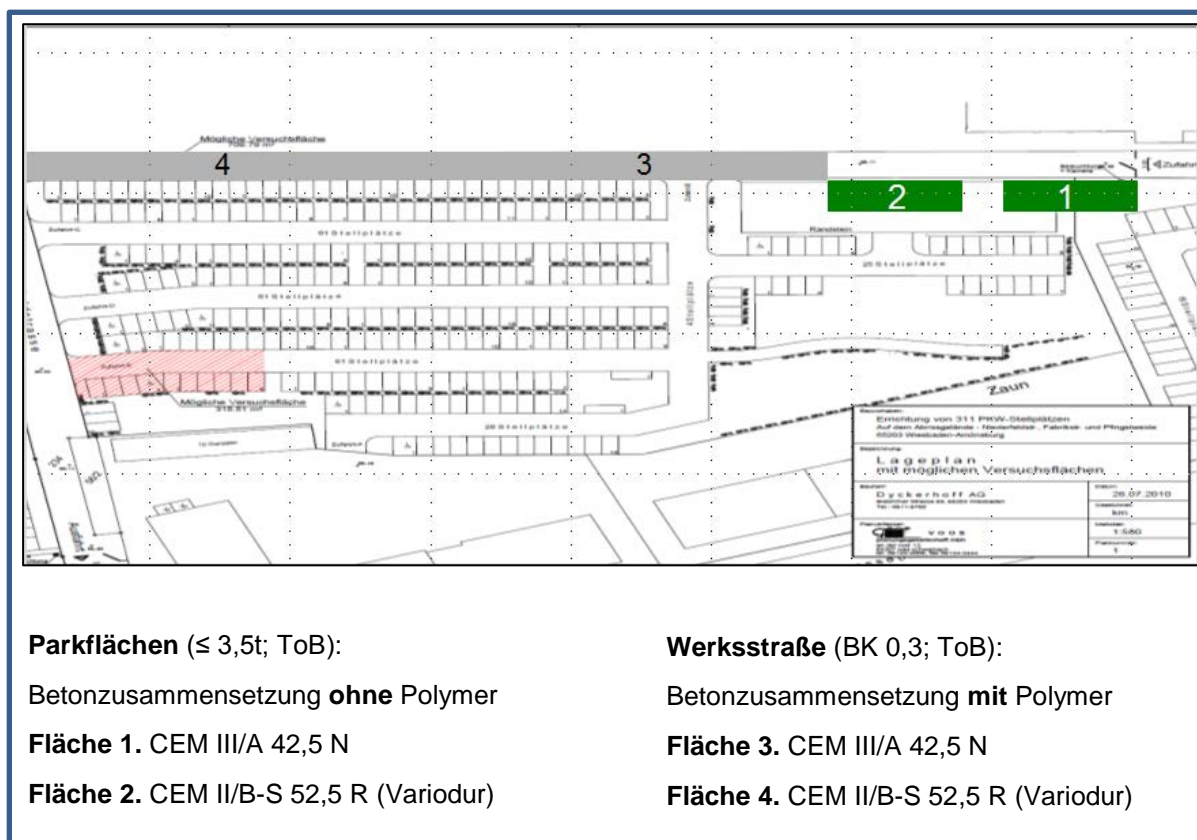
Lageplan der Versuchsflächen (Jahr 2011: Flächen 1 + 2; Jahr 2013: Flächen 3 + 4)
